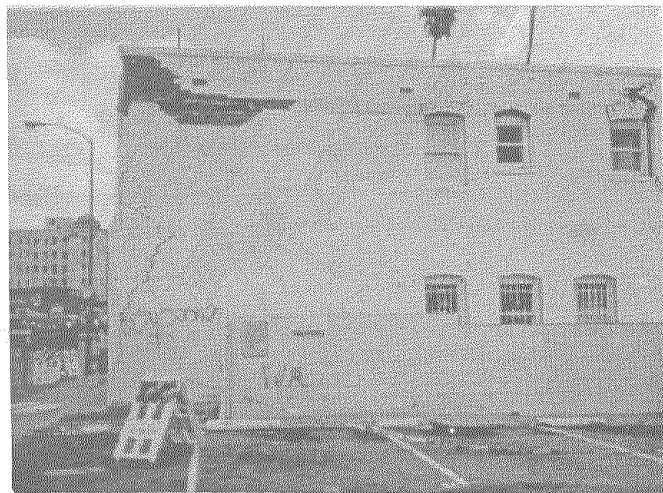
Fallas Típicas de la Mampostería sin Refuerzo
